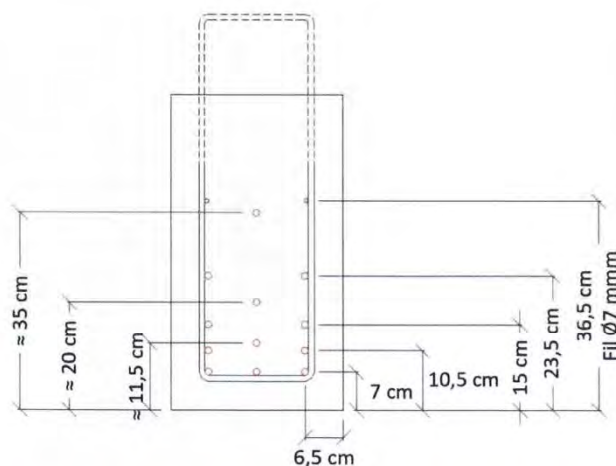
Plan de ferrailage des poutres (extrait du rapport du LERM)
